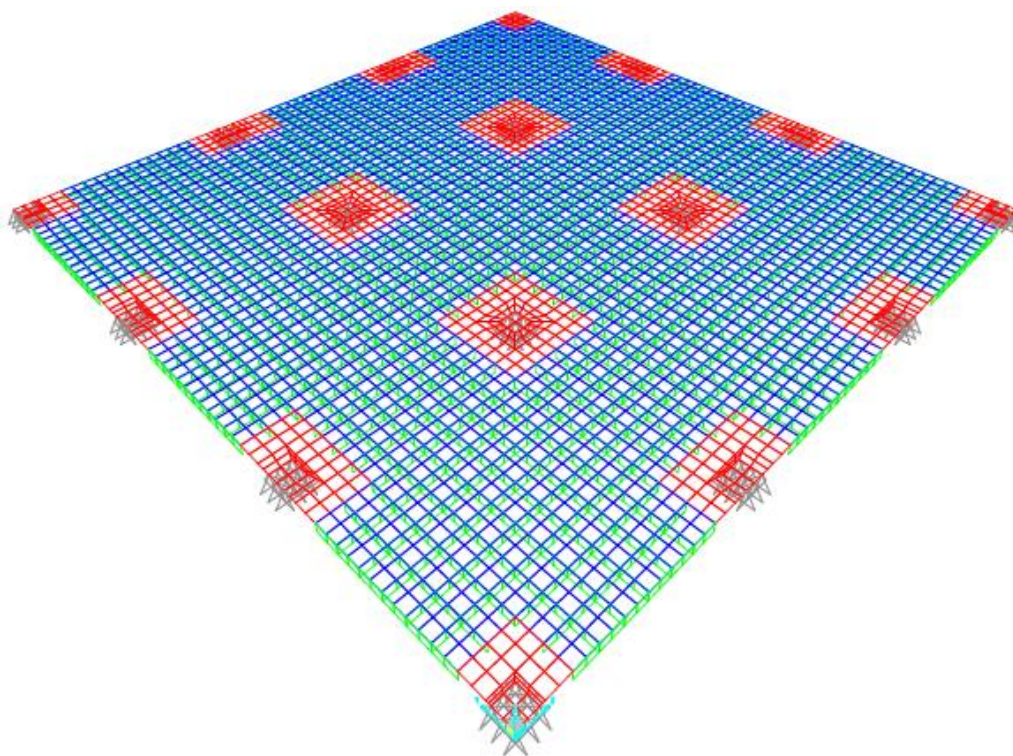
Laje desenhada no AutoCAD (vista inferior)
